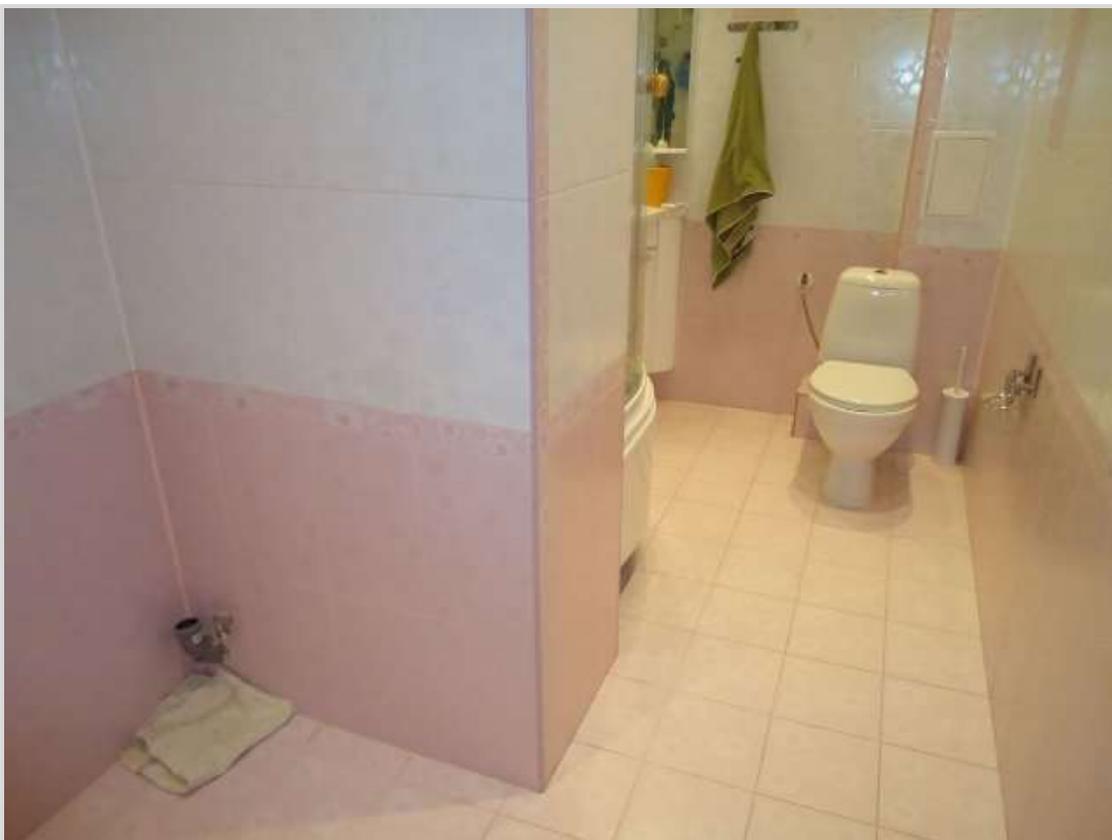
Ванная (помещение №2 на плане БТИ)
